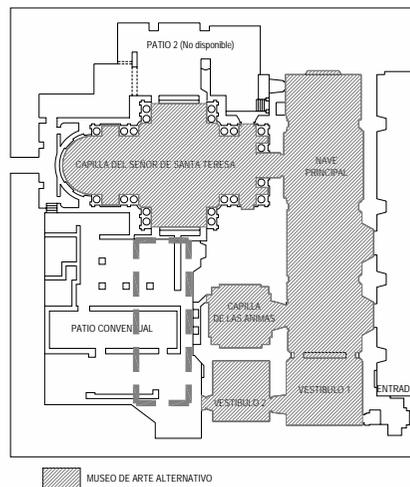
Planta del ex convento remodelado. Santa Teresa La Antigua, México D.F.
